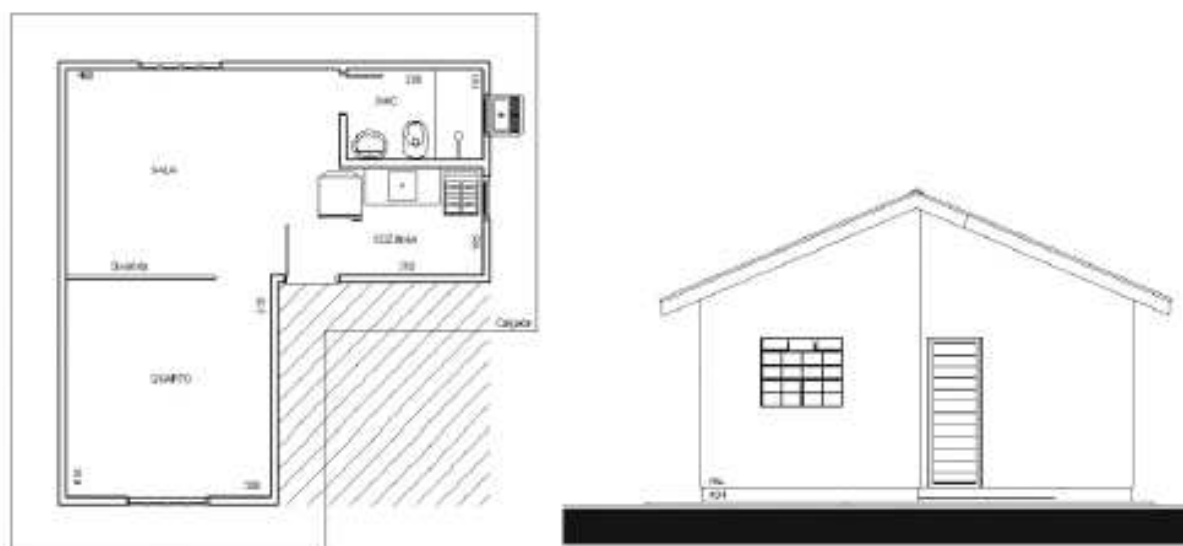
MORADIAS RIO CHAPECÓ I: PLANTA BAIXA E ELEVAÇÃO (SEM ESCALA).
